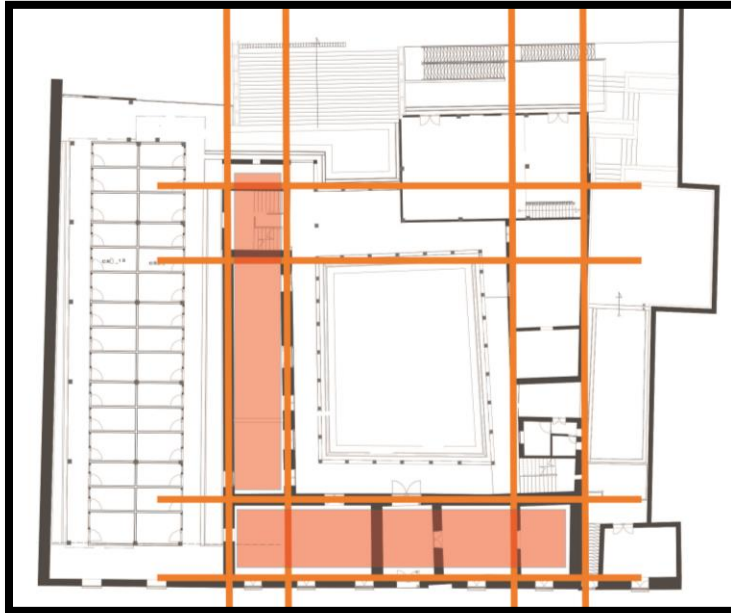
Ejes conceptuales sobre la planimetría básica del conjunto arquitectónico. Los espacios configuran un entramado cuadrangular pero la estructura tipológica es evidentemente en L.
